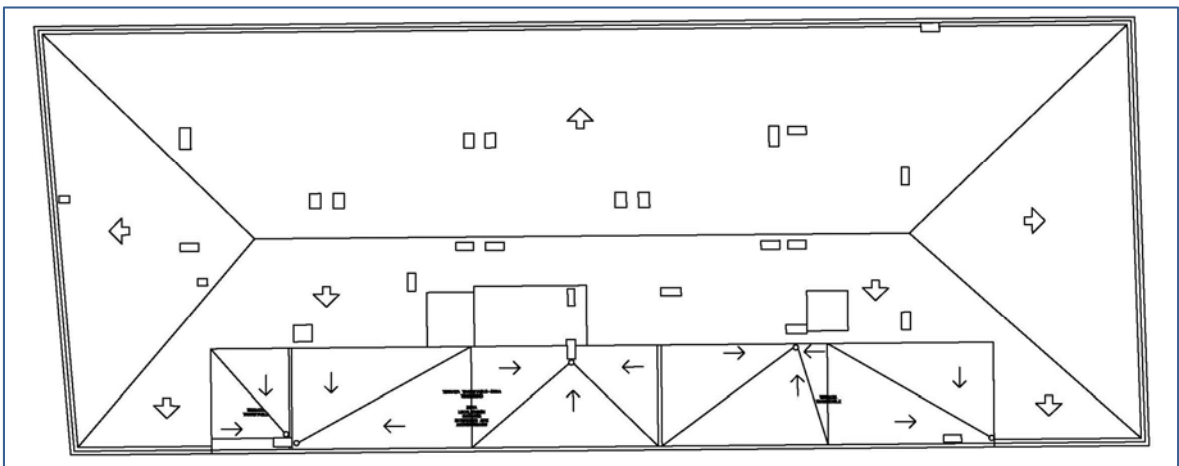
Plano de planta cubierta. Procede del Proyecto de Ejecución.
